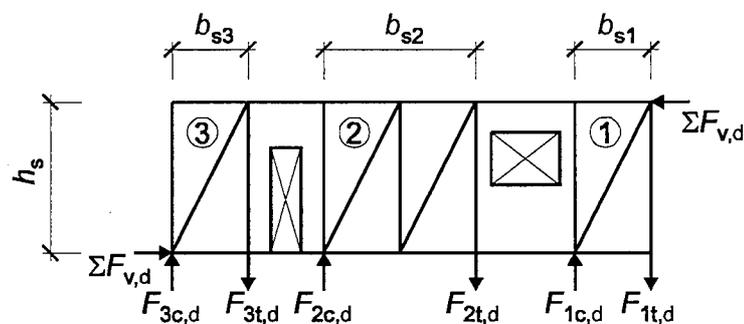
Verankerungspunkte einer Wandscheibe mit Öffnungen
